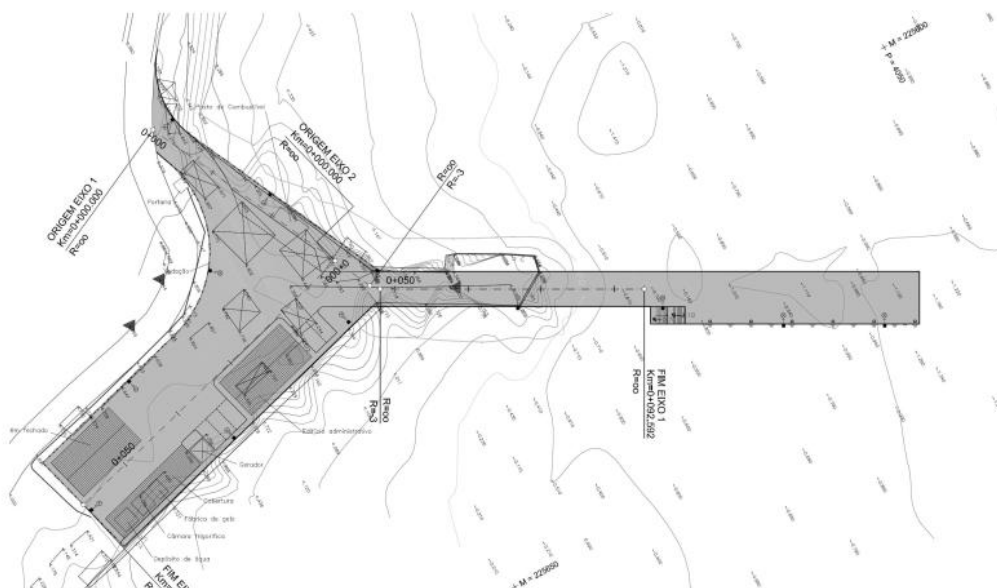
Layout geral do projeto proposto em Porto Alegre – Fonte: Projeto fornecido pelo cliente
